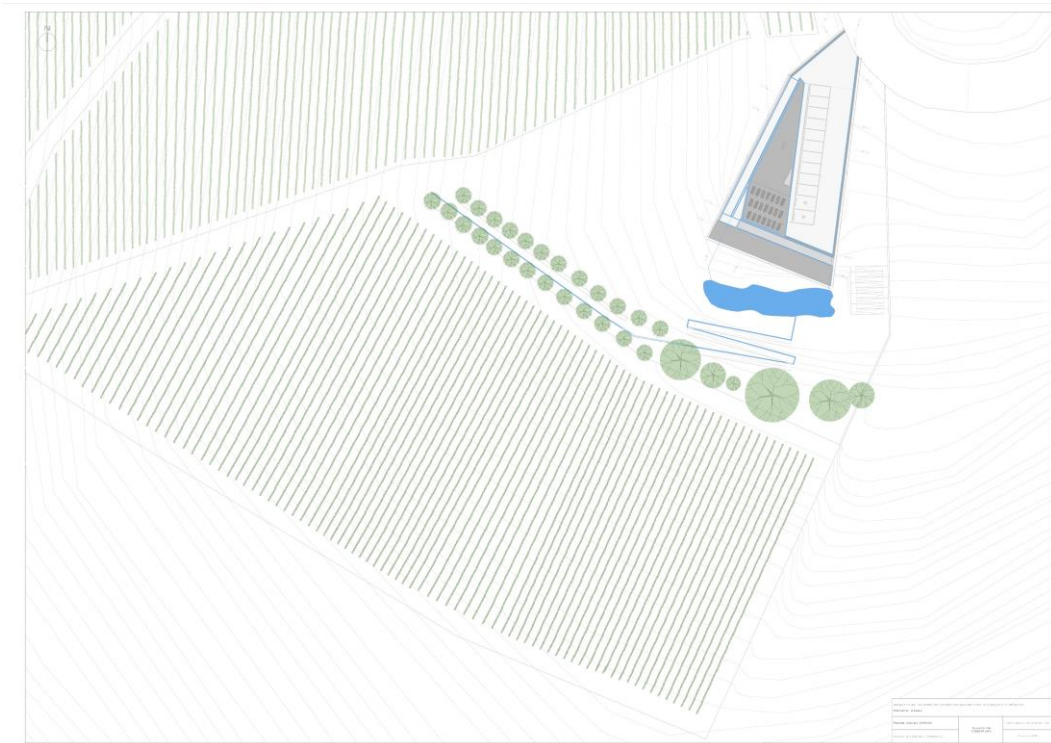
Planta de drenagem/escoamento das águas - Autor
